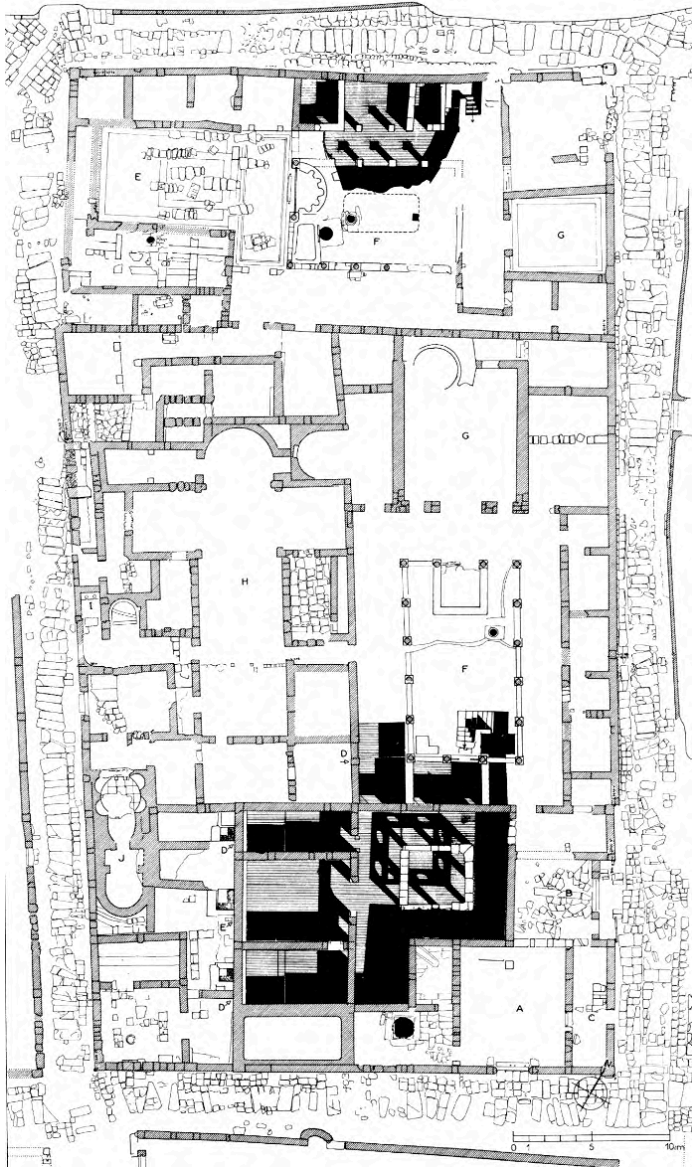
Plan du rez-de-chaussée de la Maison de la Chasse (BESCHAOUCH *et al.* 1983, p. 51.)
